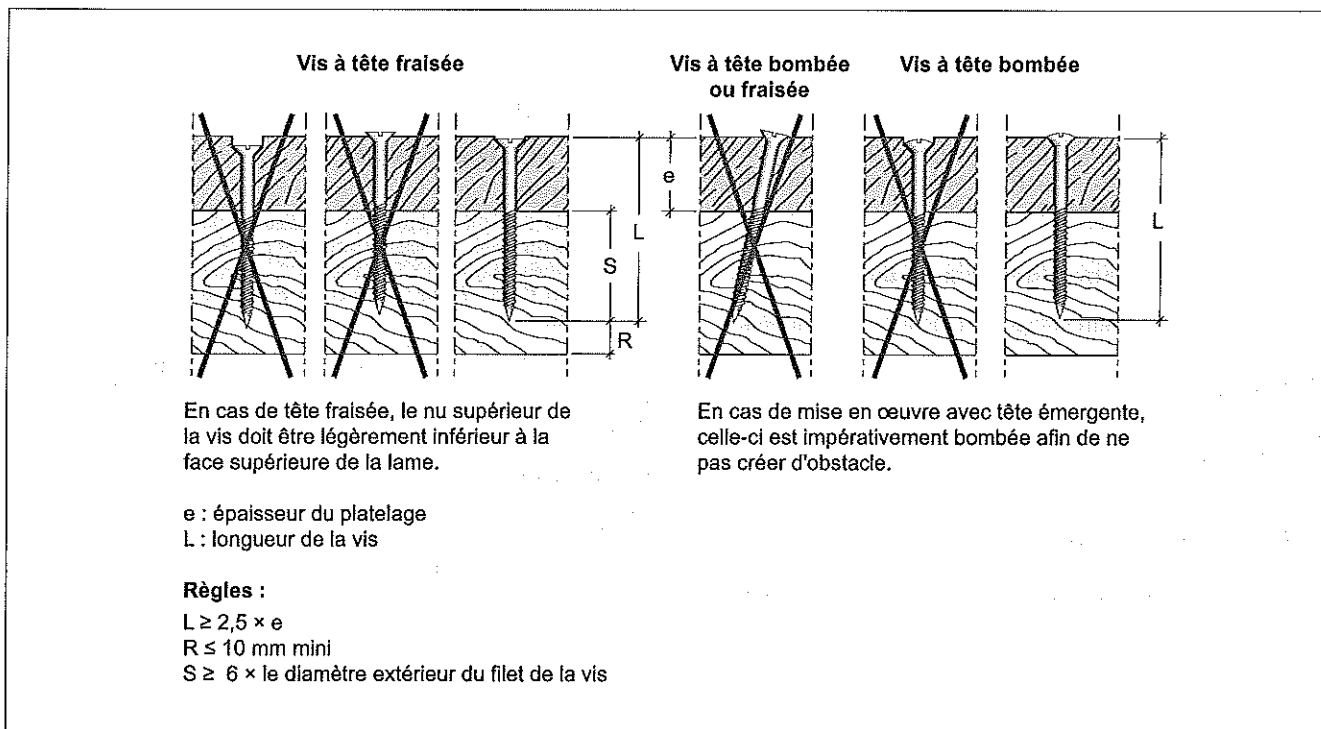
Disposition des fixations des lames de platelage sur lambourdes en bois – Coupe longitudinale sur lames de platelage, jeu en bout de lames (source : DTU 51.4).
